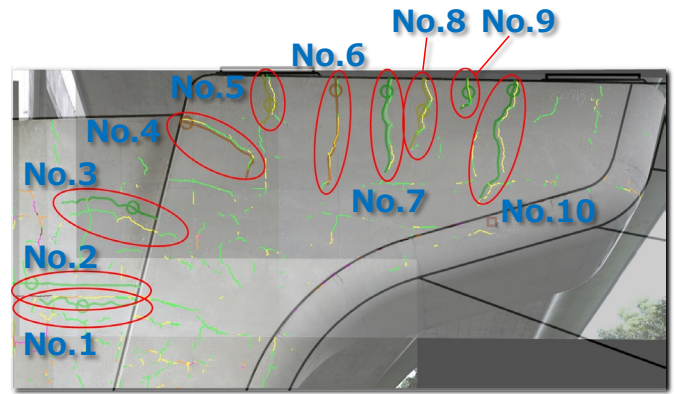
最大ひび割れ幅比較用のひび割れ番号と位置図
